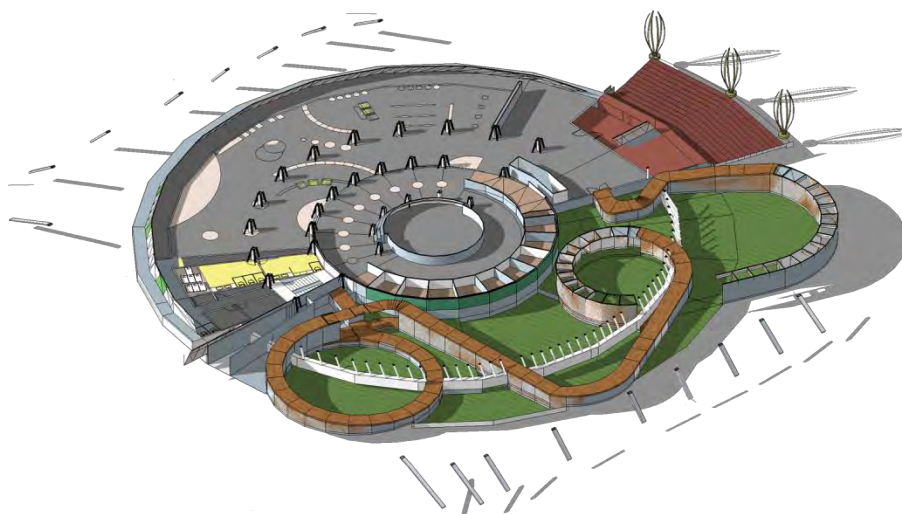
Denah Lantai 3 Bangunan Utama
